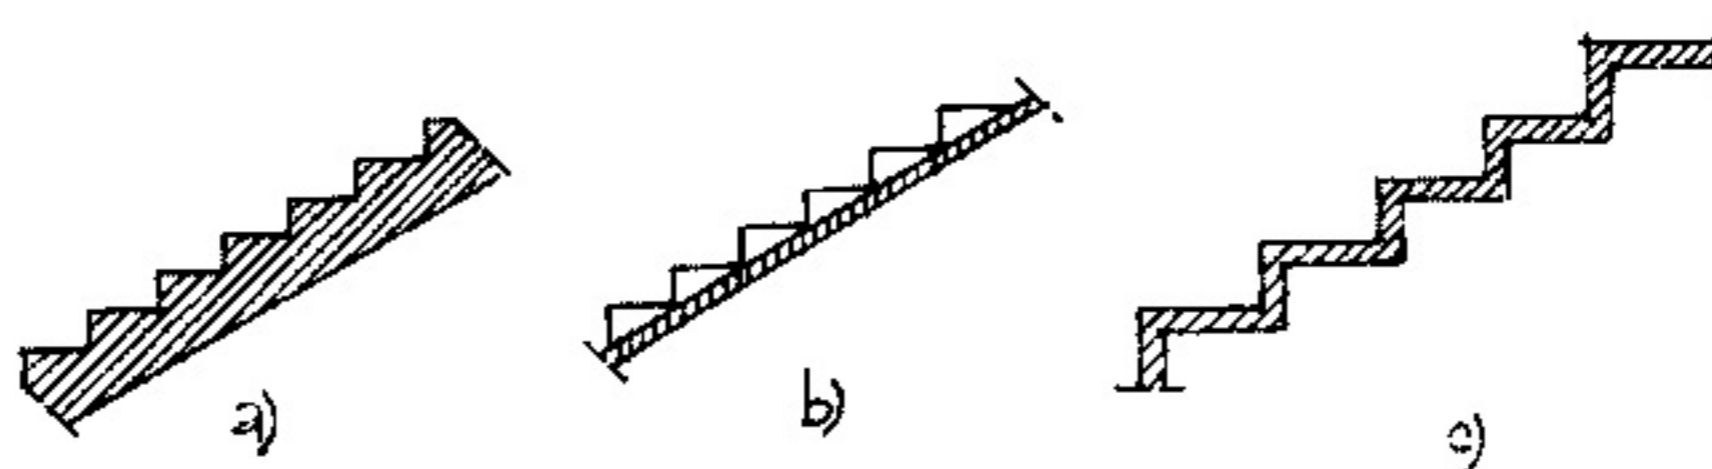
Scări din beton armat monolit; a - cu trepte turnate odată cu rampa; b - cu trepte turnate după execuția rampei; c - ortogonale
